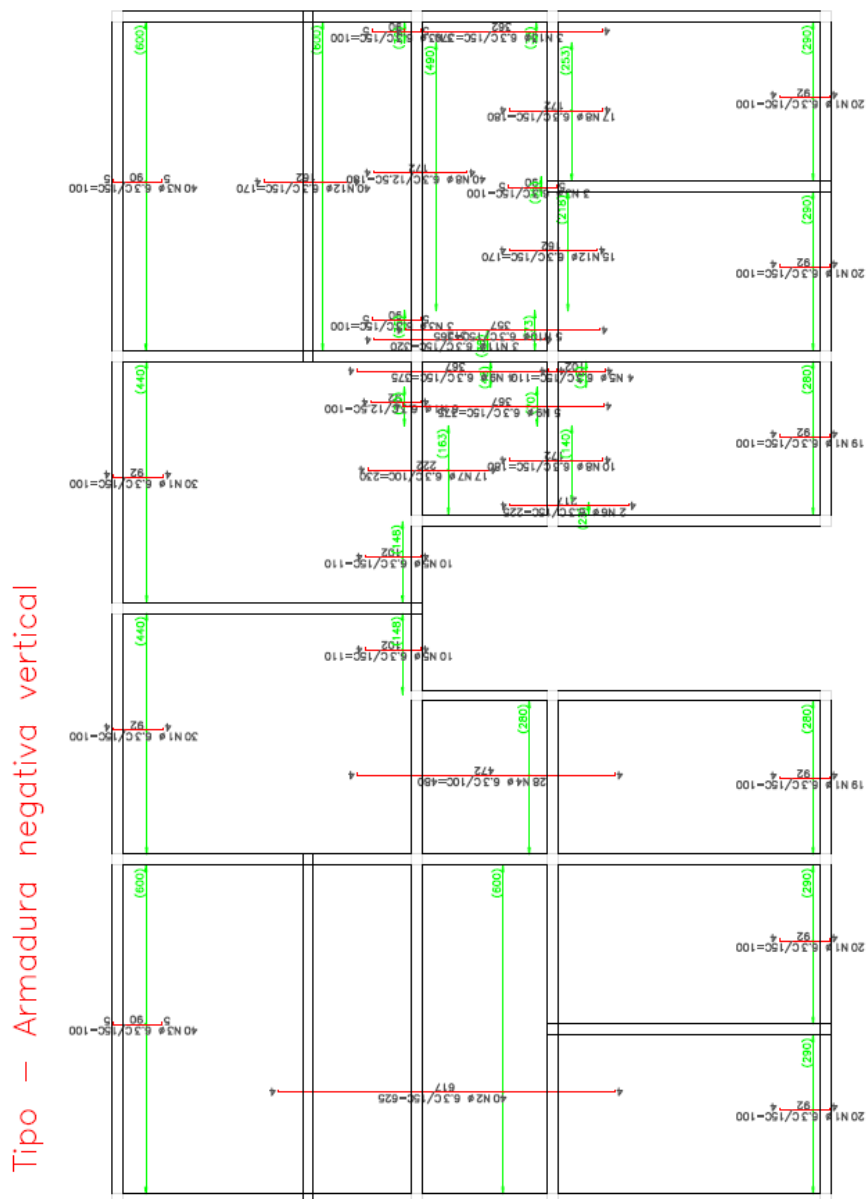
Simplificação da disposição das armaduras negativas nas lajes
